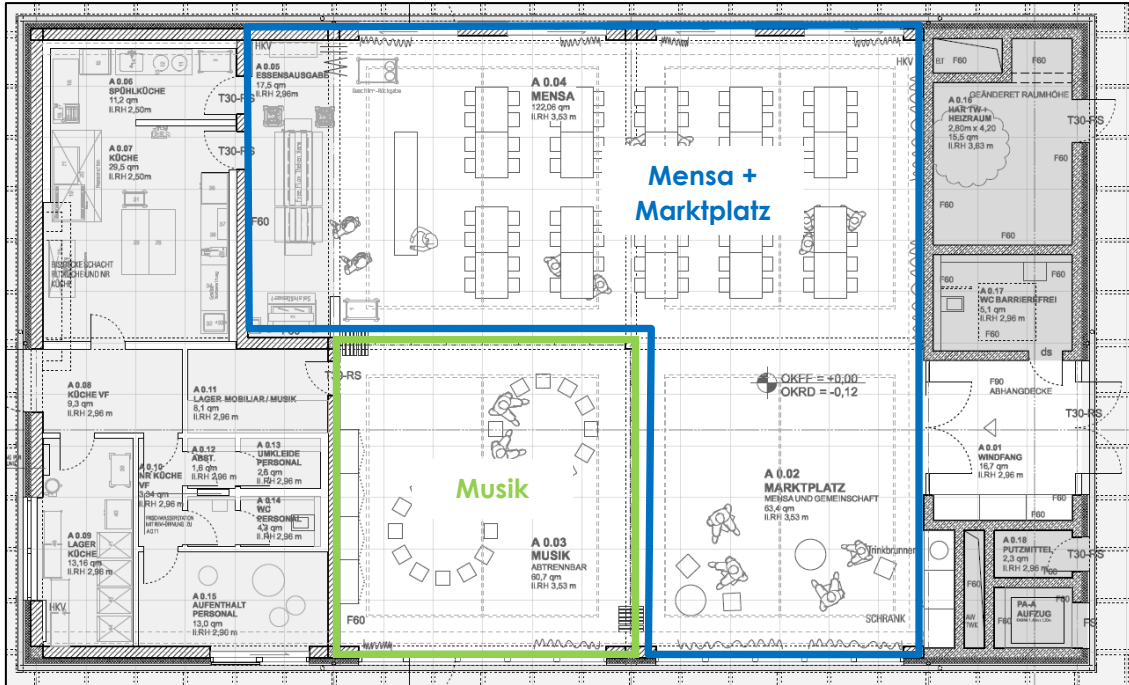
Gemeinschaftshaus, Grundriss EG, unmaßstäblich /13/
